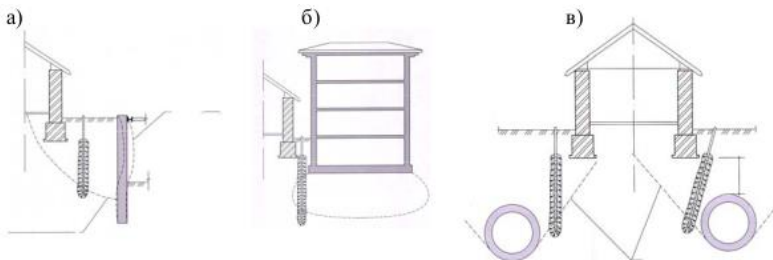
Захист фундаментів існуючої будівлі за допомогою геотехнічного бар'єру
